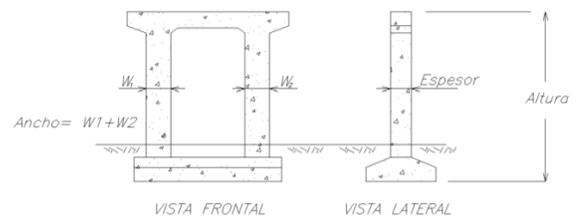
Pila tipo marco. Fuente: MOPT (2007)
